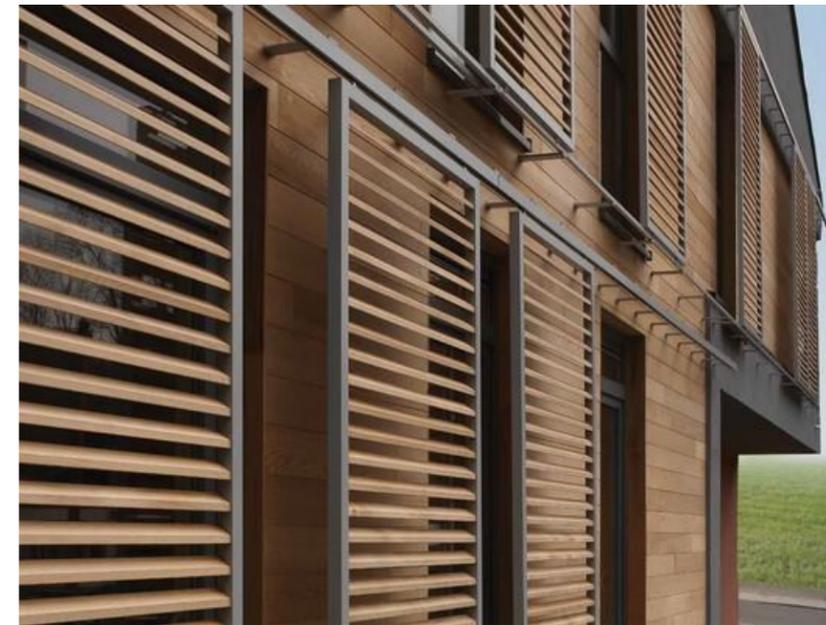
Imagen de referencia. Extraída de: <https://www.archdaily.co/co/929085/parasoles-fijos-y-moviles-10-protecciones-solares-para-fachadas>
